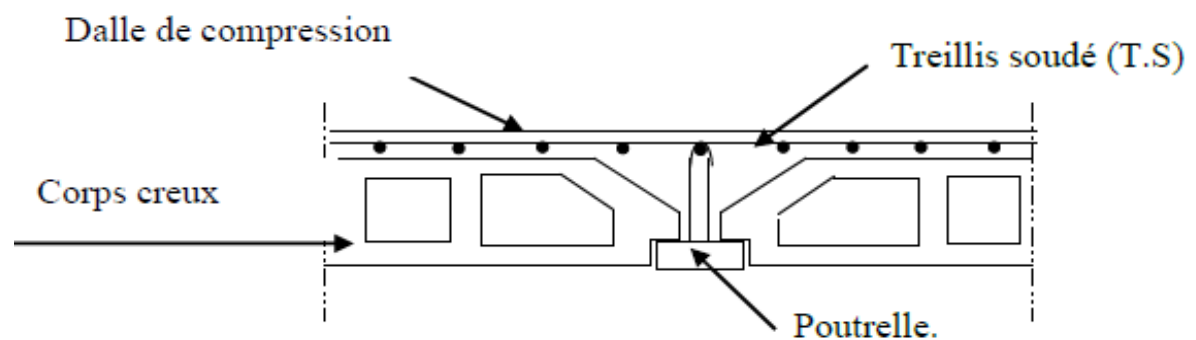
Schéma descriptif d'un plancher courant.
